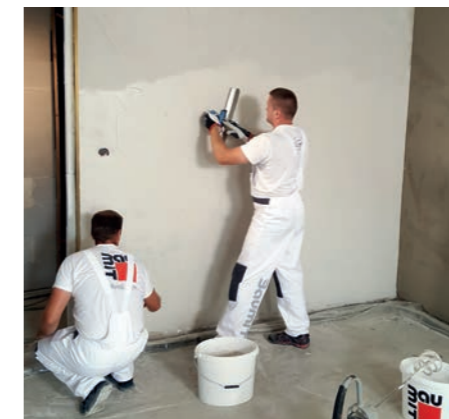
Následně se povrch omítky nahrubo stahuje hliníkovou latí „h-profilu“ do roviny. Popřípadě se dostříká materiál na požadovanou tloušťku vrstvy.
